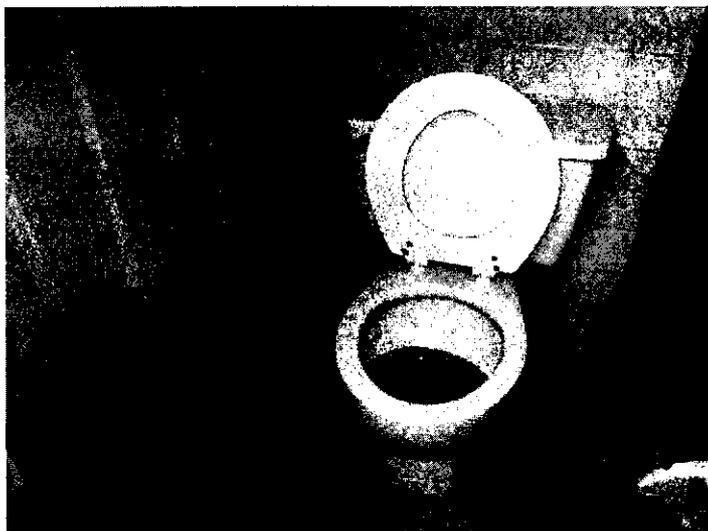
División frontal en baños, debe ser reemplazada por división en acero inoxidable
